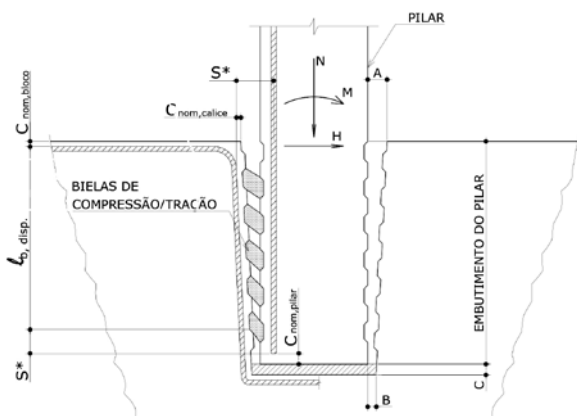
Esquema geral do funcionamento do traspasse das armaduras, na ligação pilar/fundação
